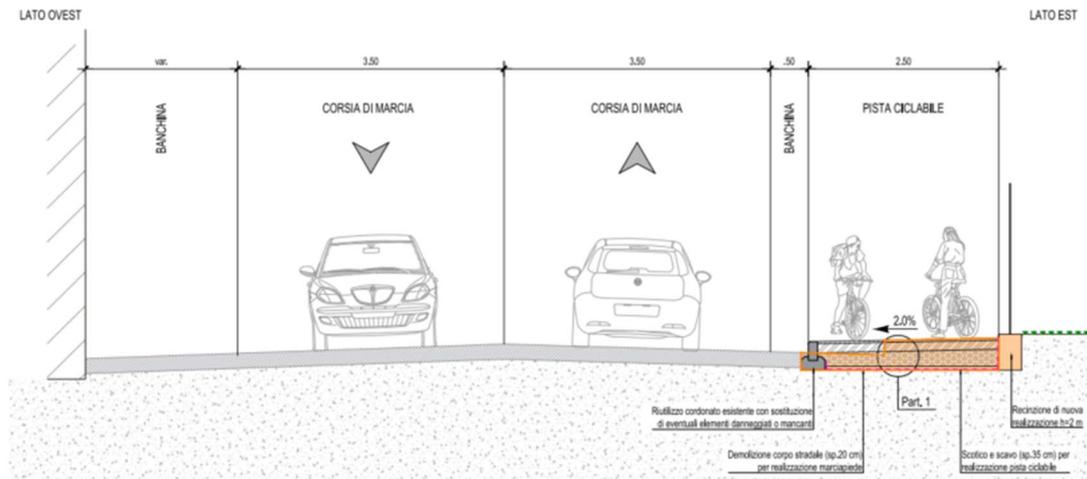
Sezione tipo Strada Provinciale Salaiola – secondo tratto
